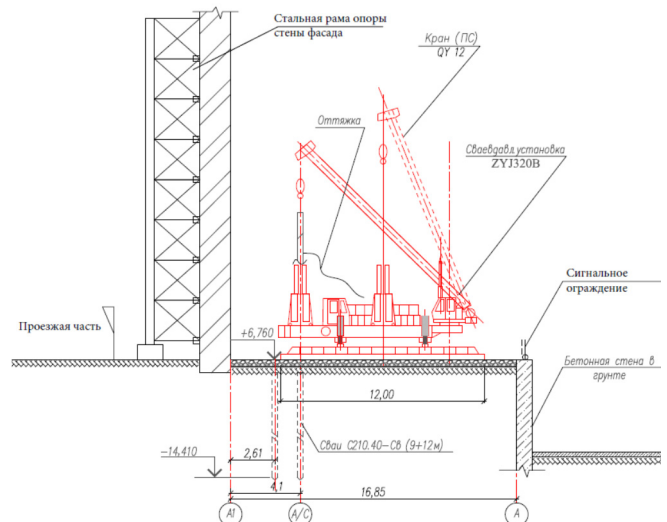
Разрез участка работ при вдавливании свай вблизи стены фасада
